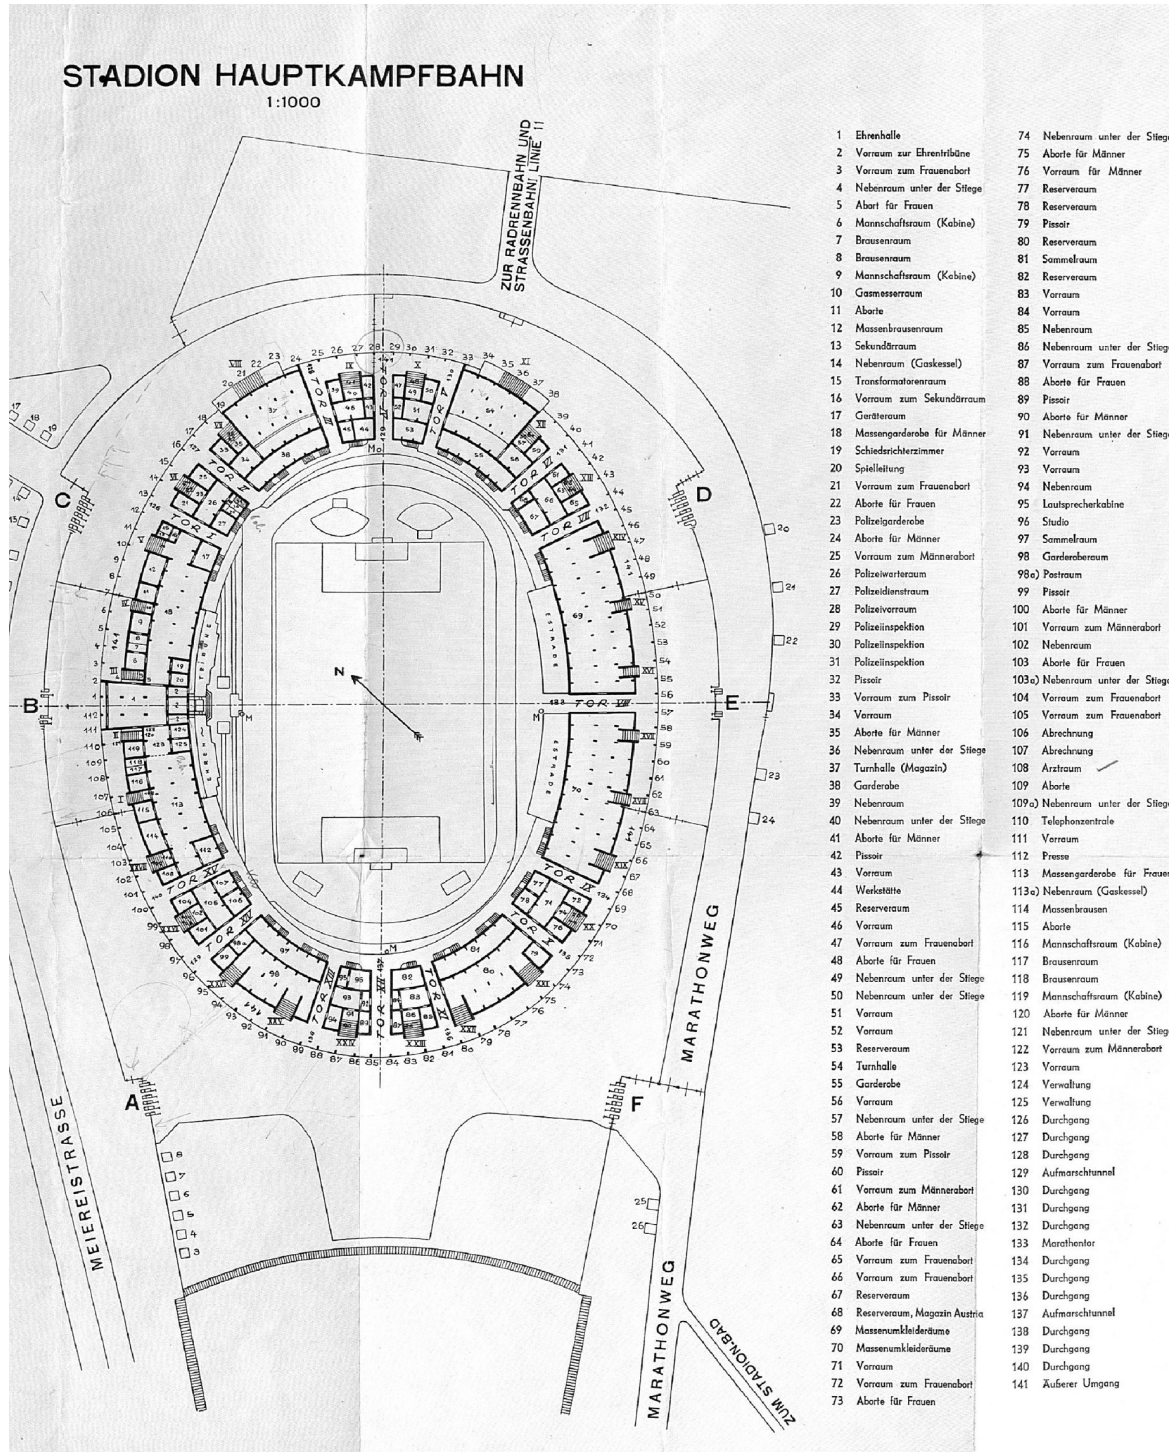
Grundrissplan des Stadions mit Raumprogramm (Bild: WStLA)
